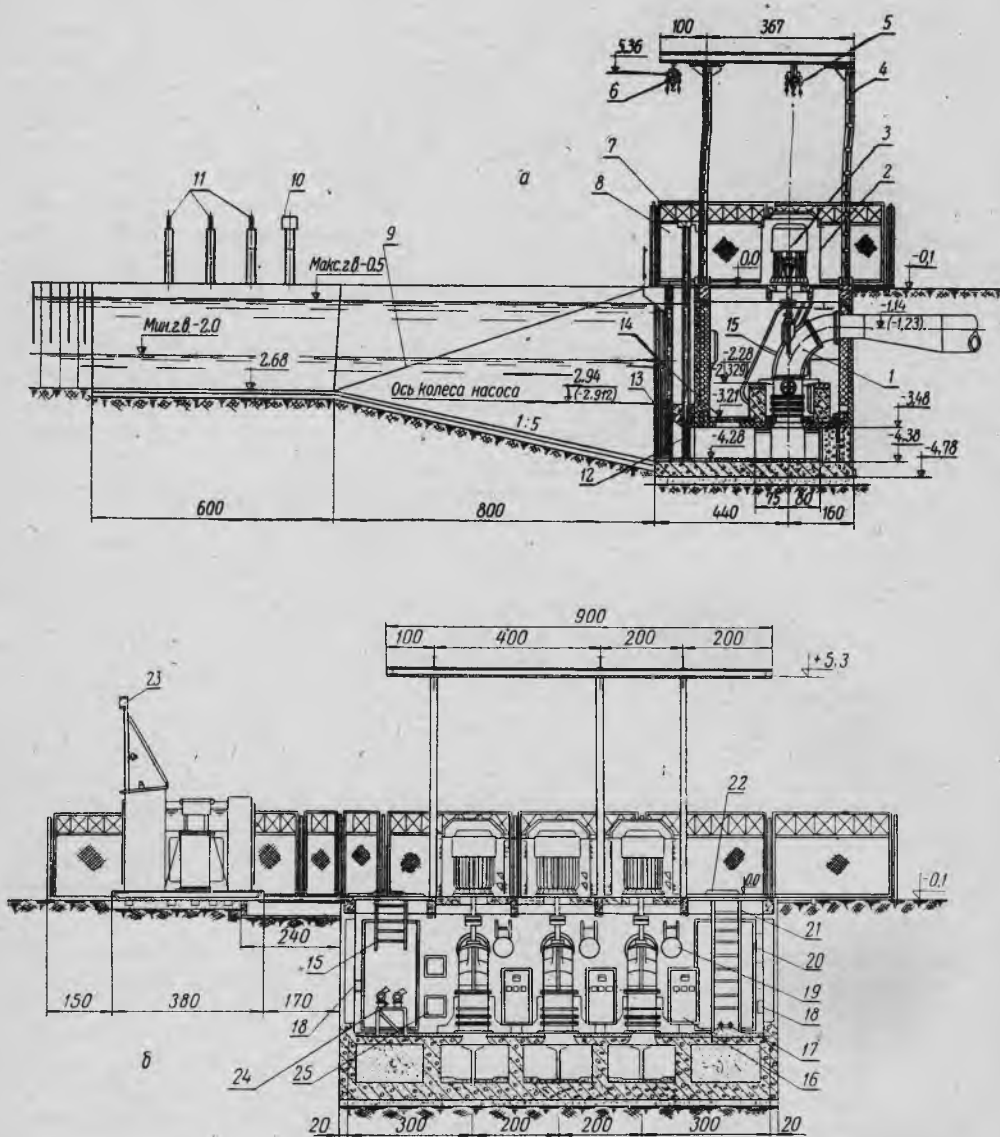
Открытая оросительная станция из сборных железобетонных элементов:
